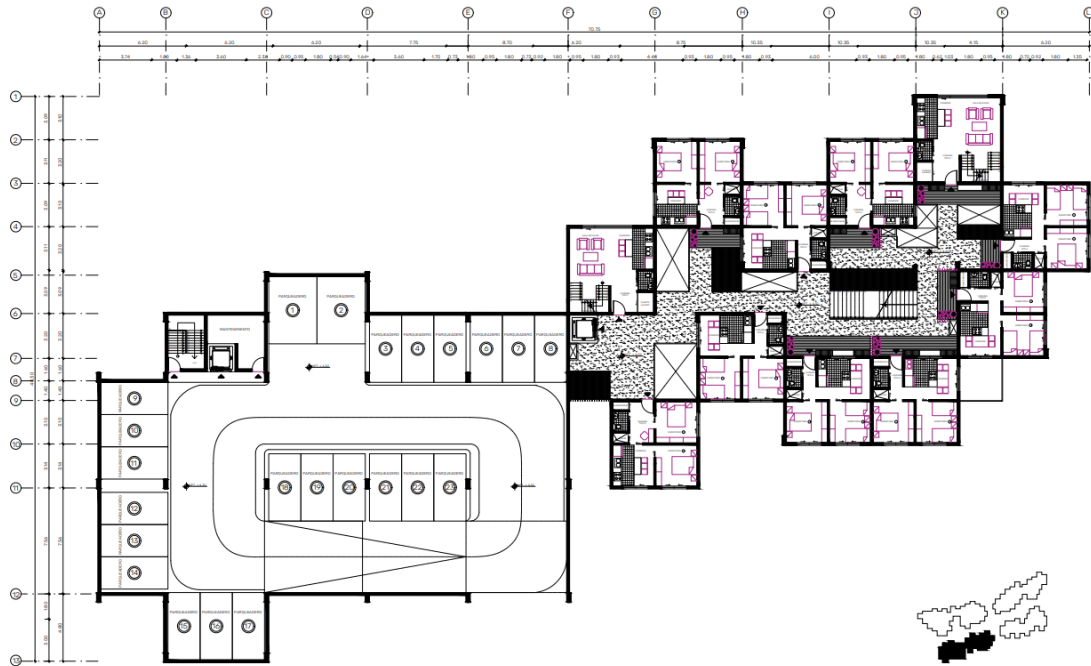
Planta Baja Bloque 3. Elaboración propia 2023
